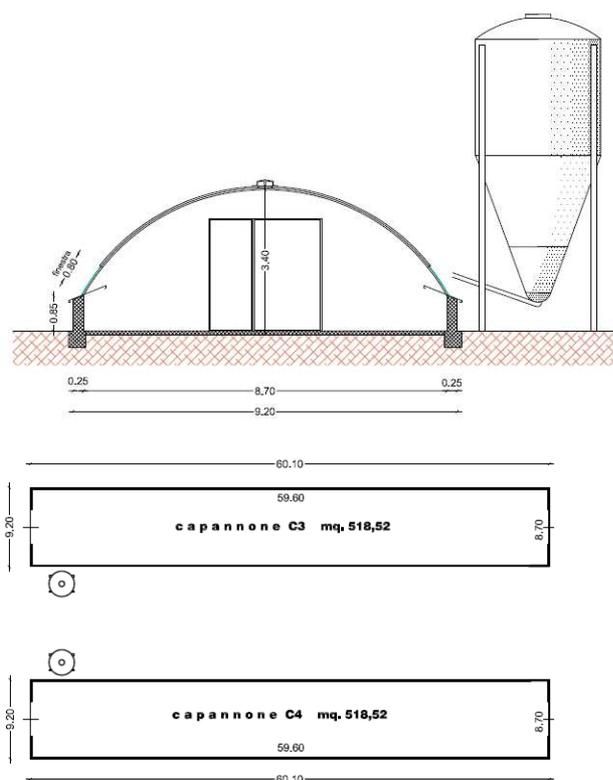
Sezione e pianta dei capannoni C3 e C4 (fonte: A. I. A.)
